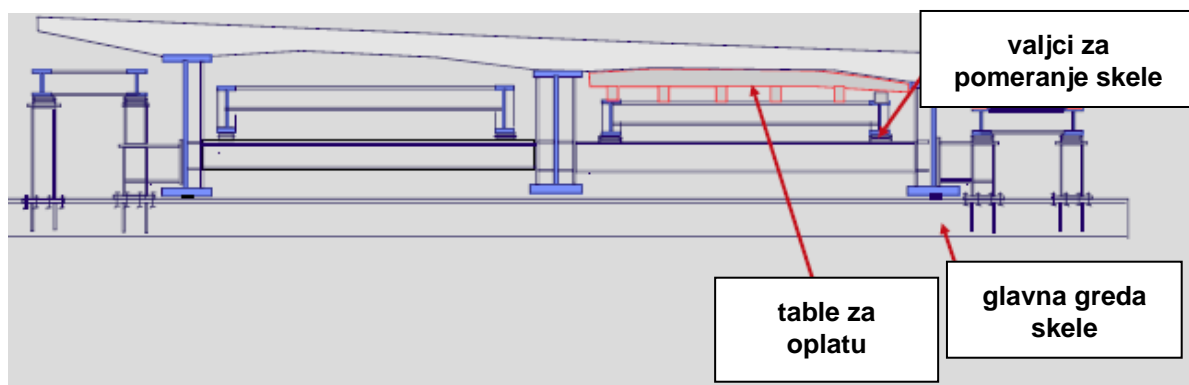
Redosled betoniranja ploče i poprečne grede
